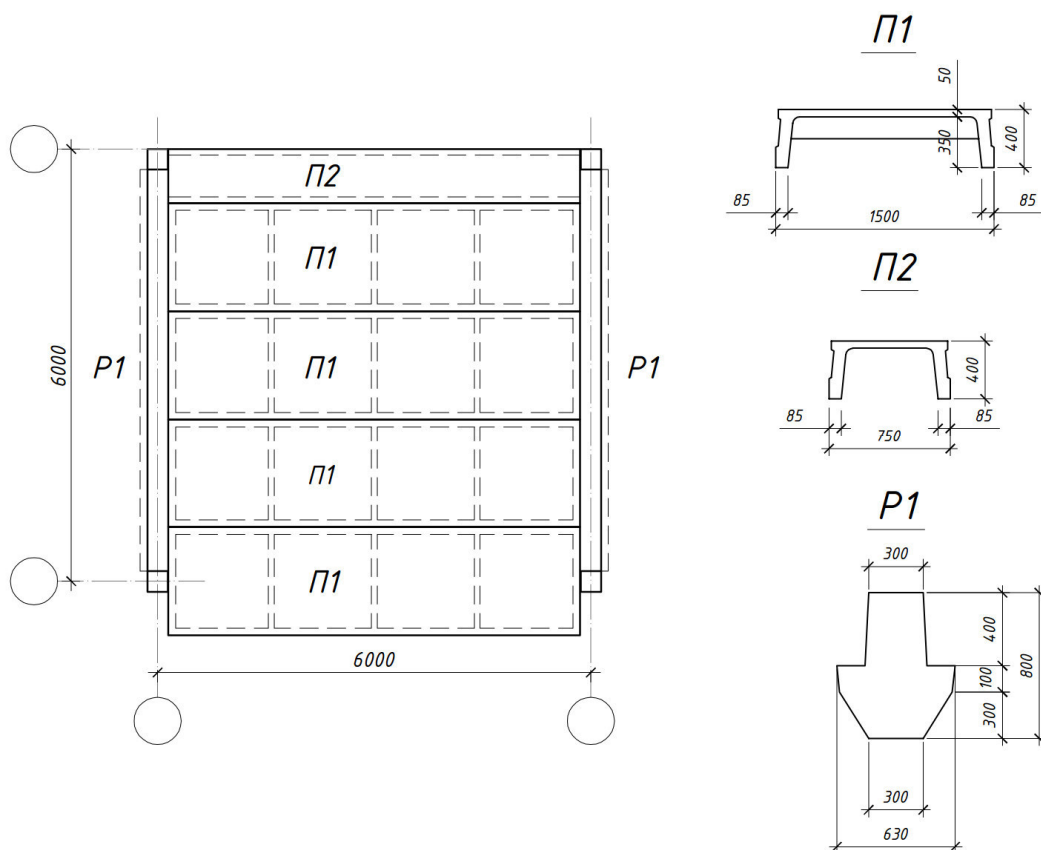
Фрагмент схемы раскладки несущих конструкций перекрытия
